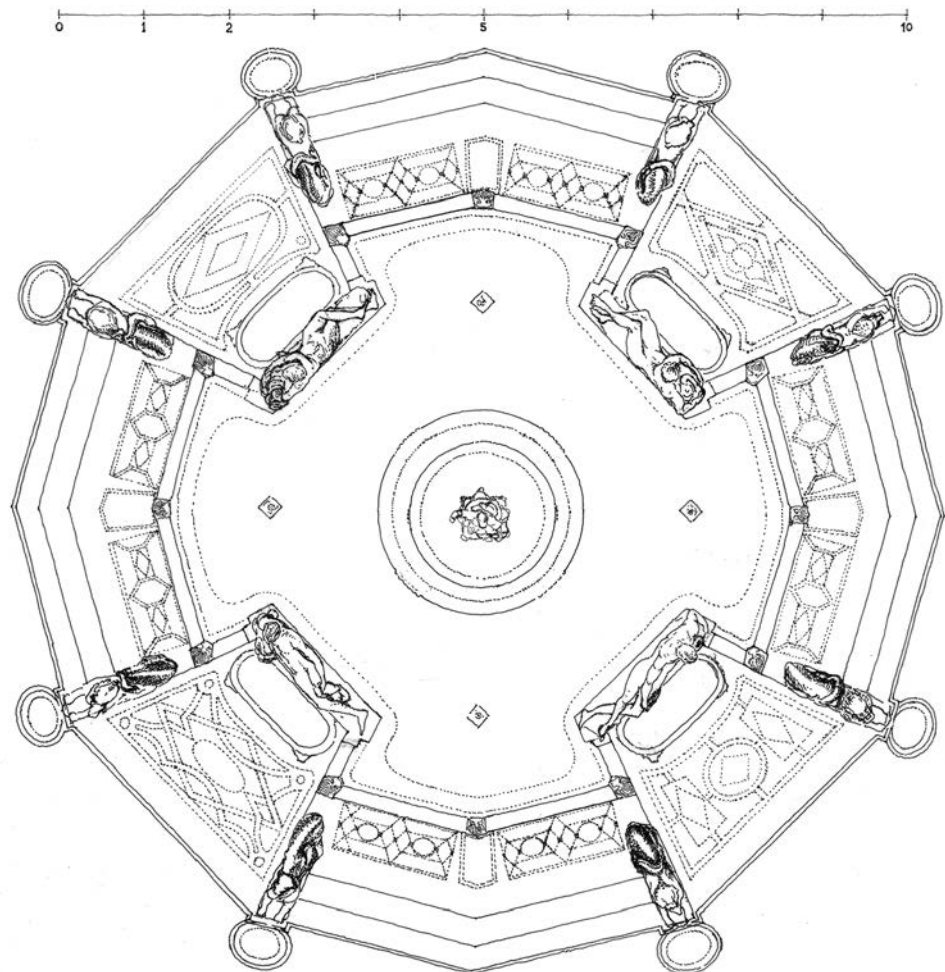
Planimetria restituita da ortofoto su nuvola di punti.
